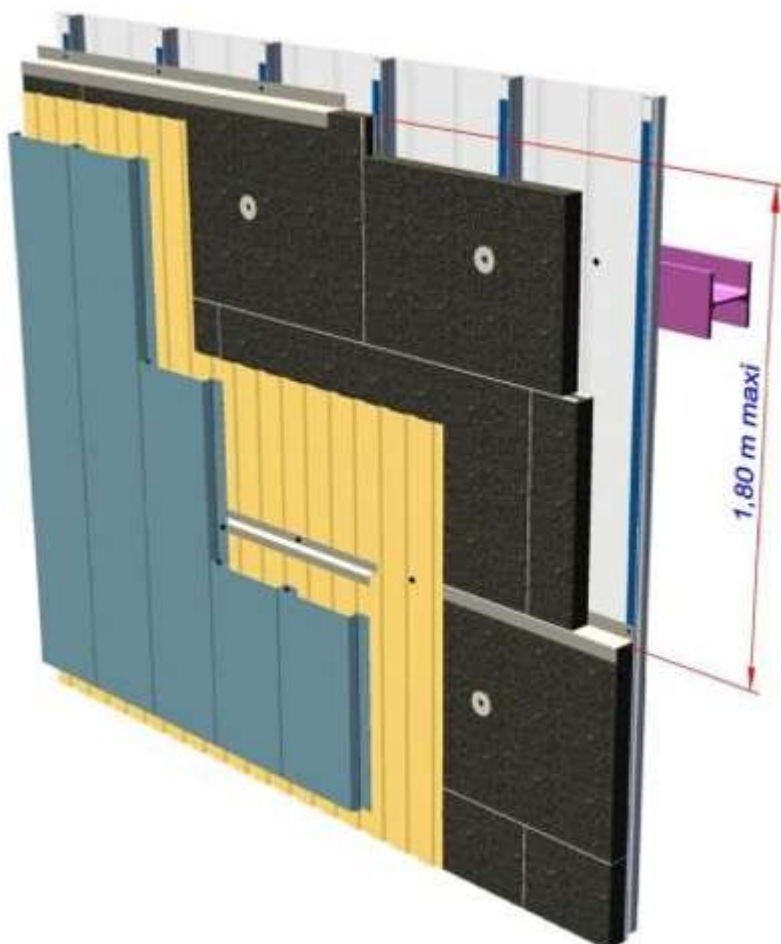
Vue en perspective (exemple : plateaux verticaux 1^{er} écarteur horizontal, peau d'étanchéité verticale, 2^{ème} écarteur horizontal et peau extérieure verticale).
